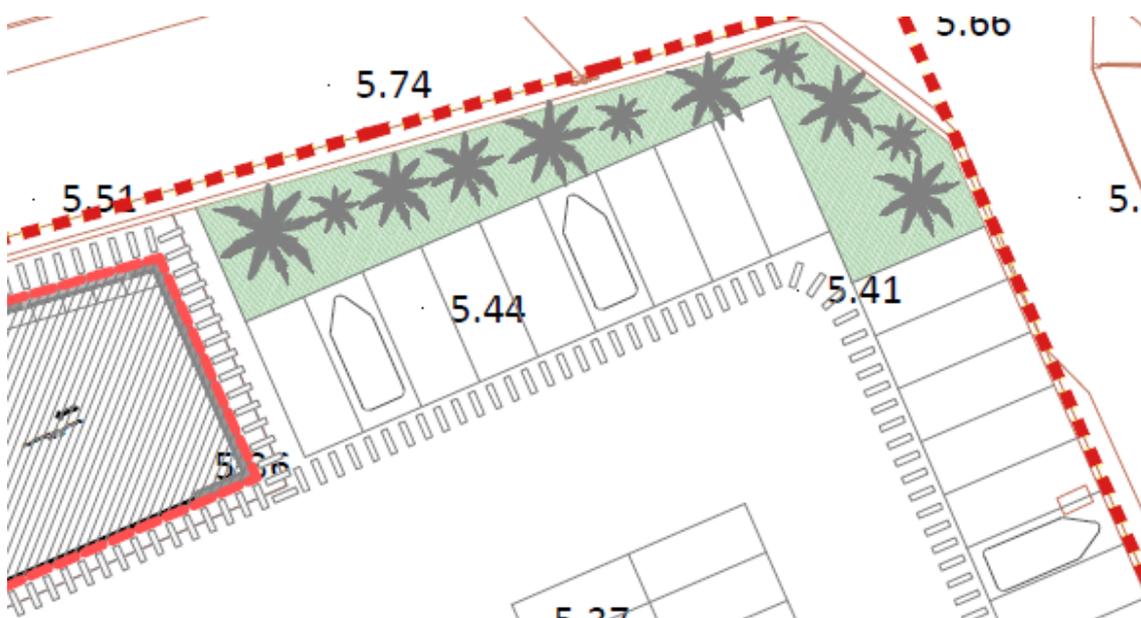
Planta geral do projeto. Área de jardim junto à extremidade nascente do edifício. (Fonte: parecer setorial da ICNF, fevereiro de 2024)
